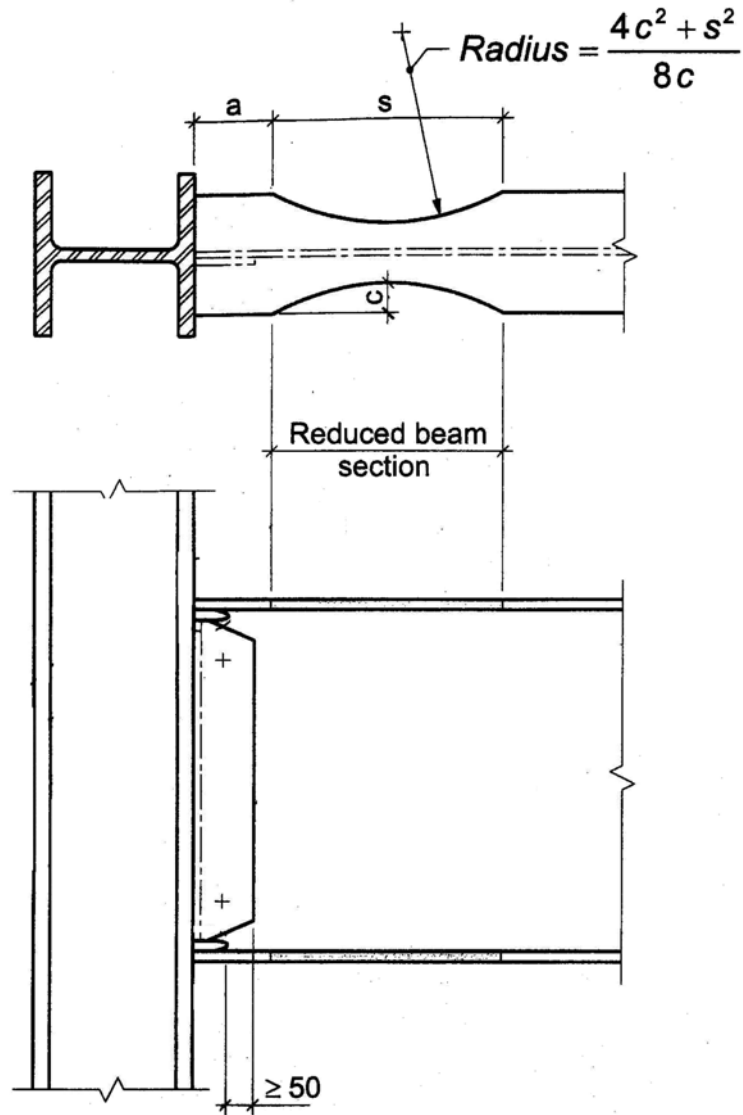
e. Poutre avec réduction de section « dogbone » (os de chien, vu sa forme) ou « RBS » (Reduced Beam Section). Ailes soudées, âme soudée à un gousset soudé à la semelle du poteau.
